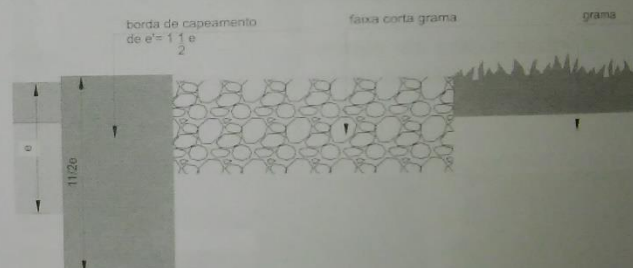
Pavimento protegido por uma borda de concreto com uma espessura de $1/2$ a espessura do pavimento.
